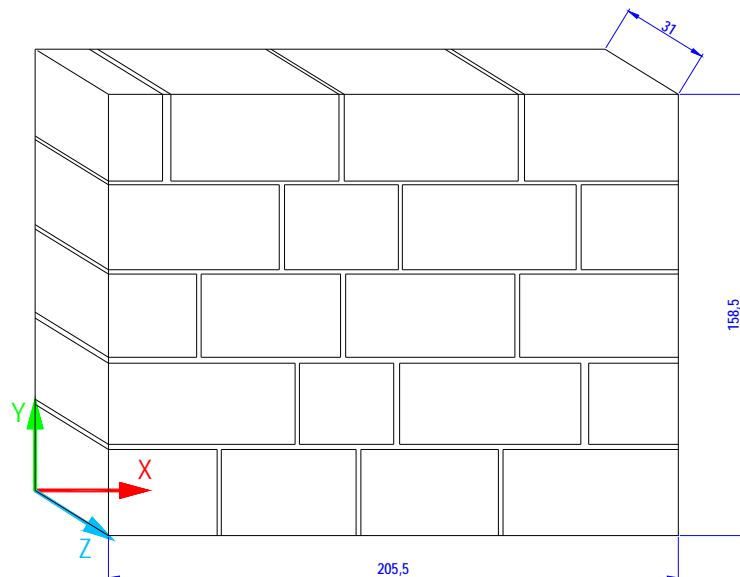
Geometría del muro de sillería. Las cotas indicadas están en cm.
